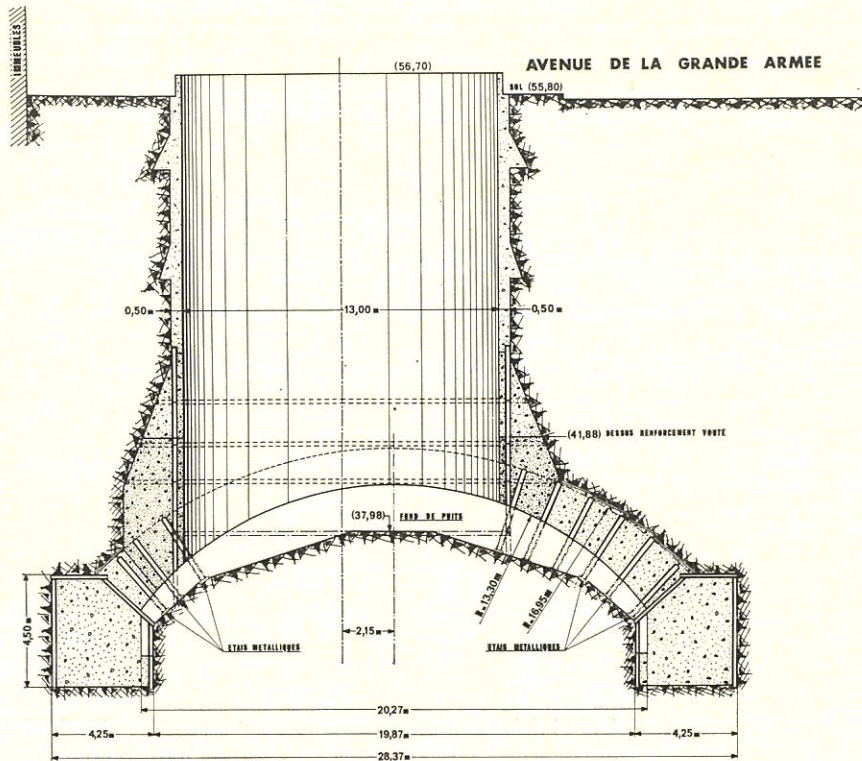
Partie Ouest de la station (50 m). Puits principal et ouvrage d'intersection.
